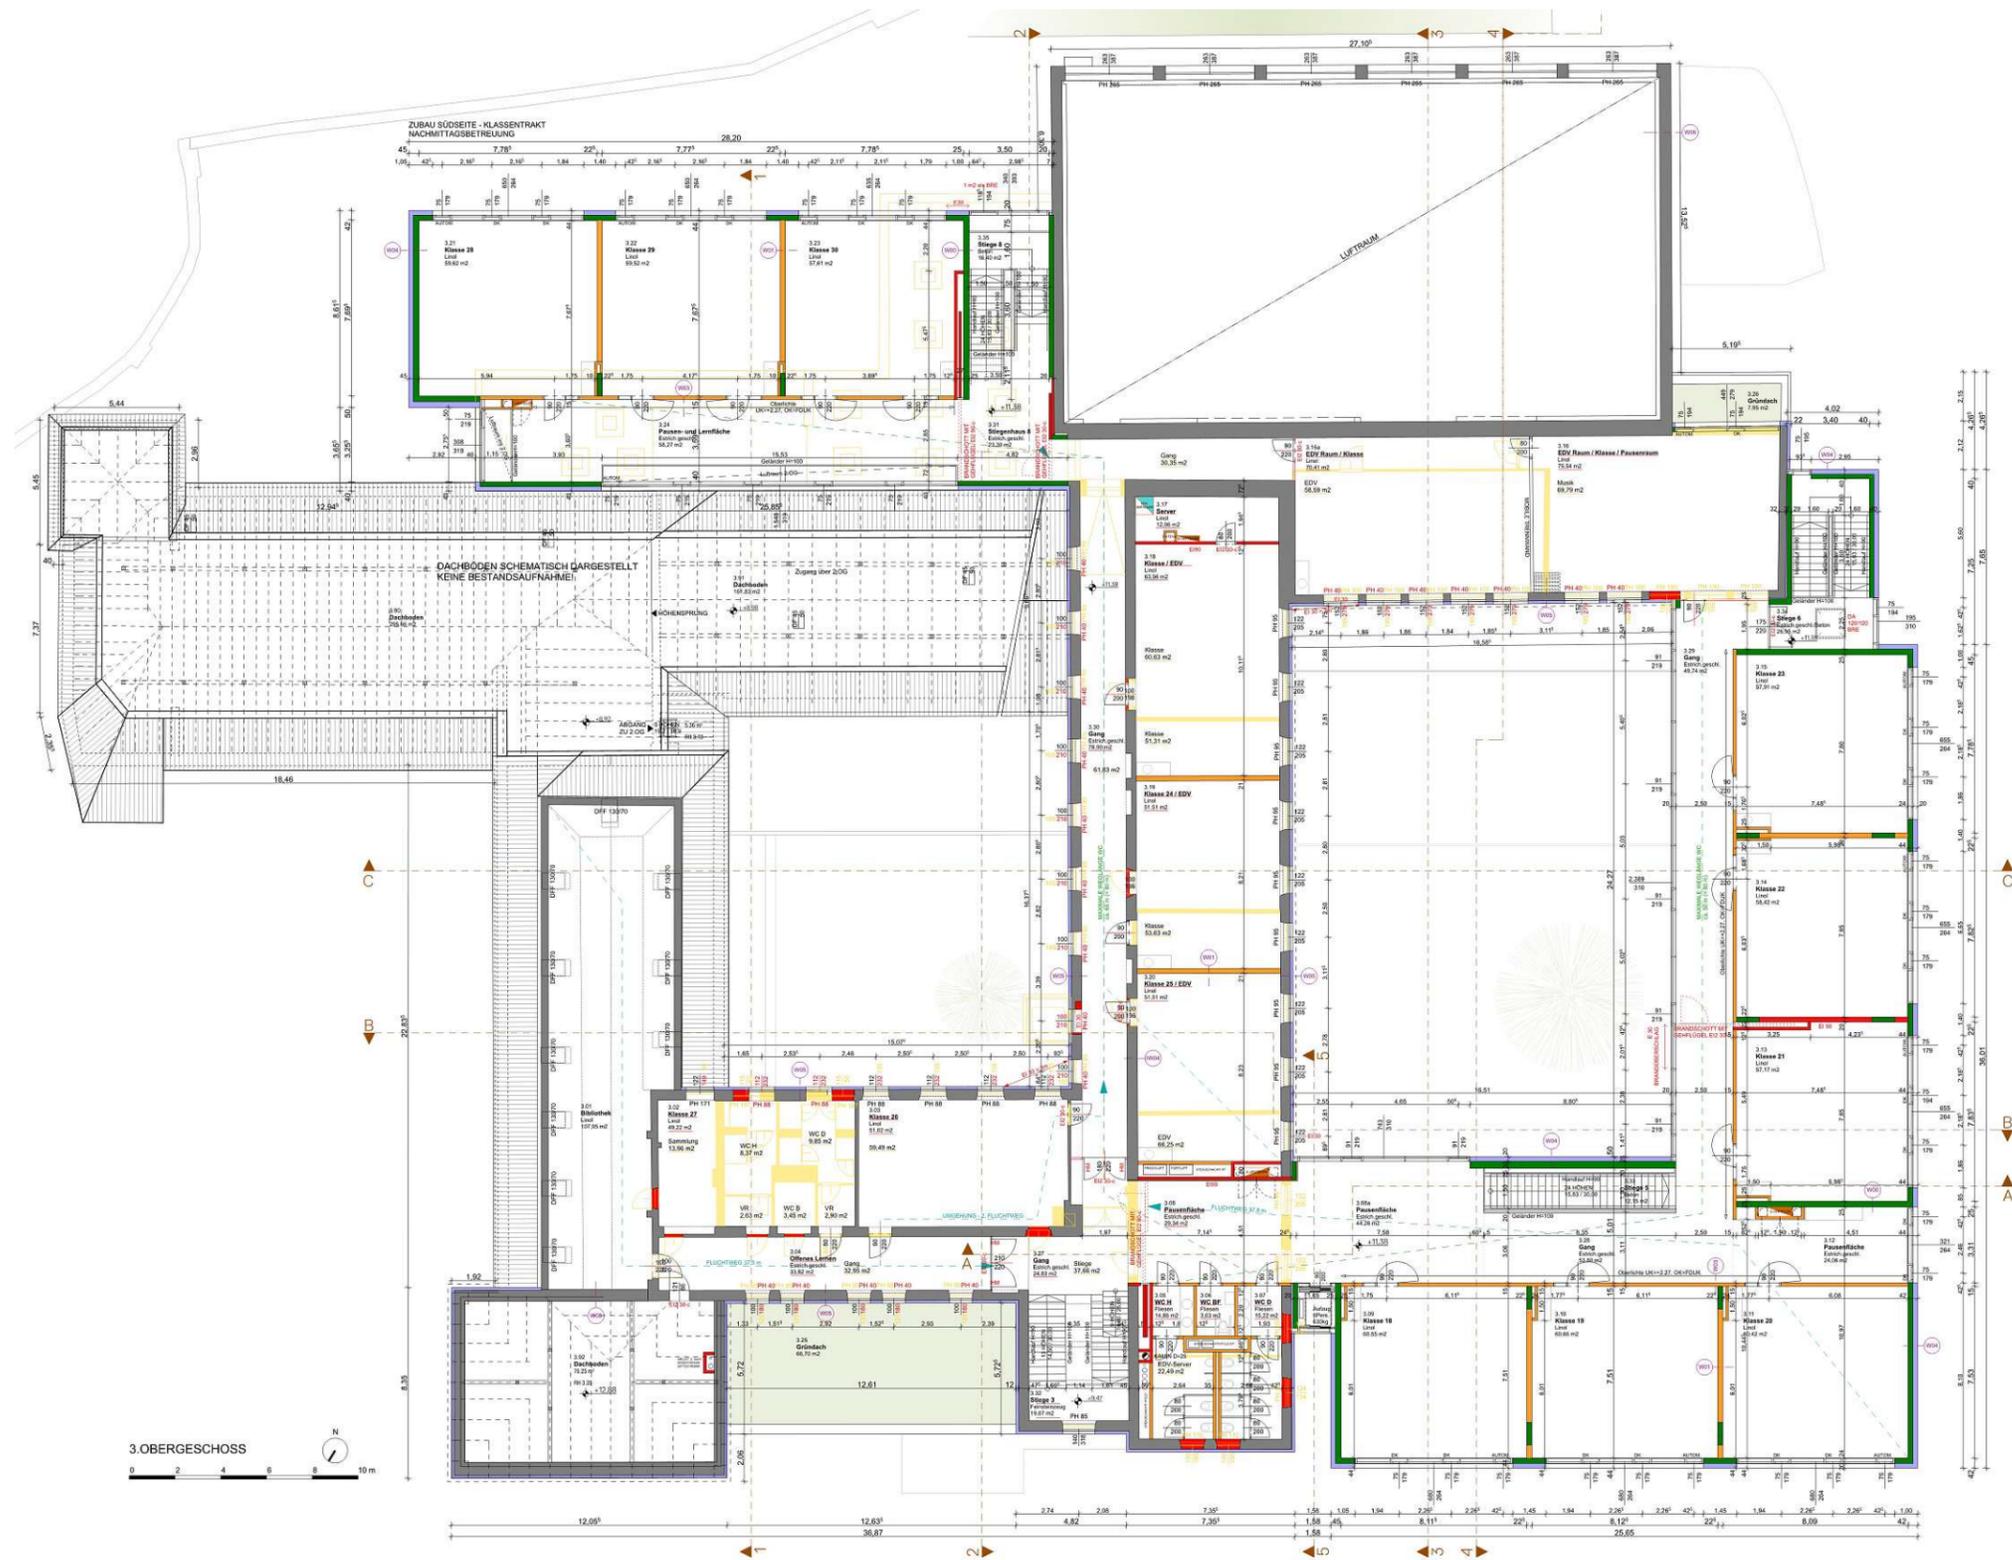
Grundriss 3. Obergeschoss
